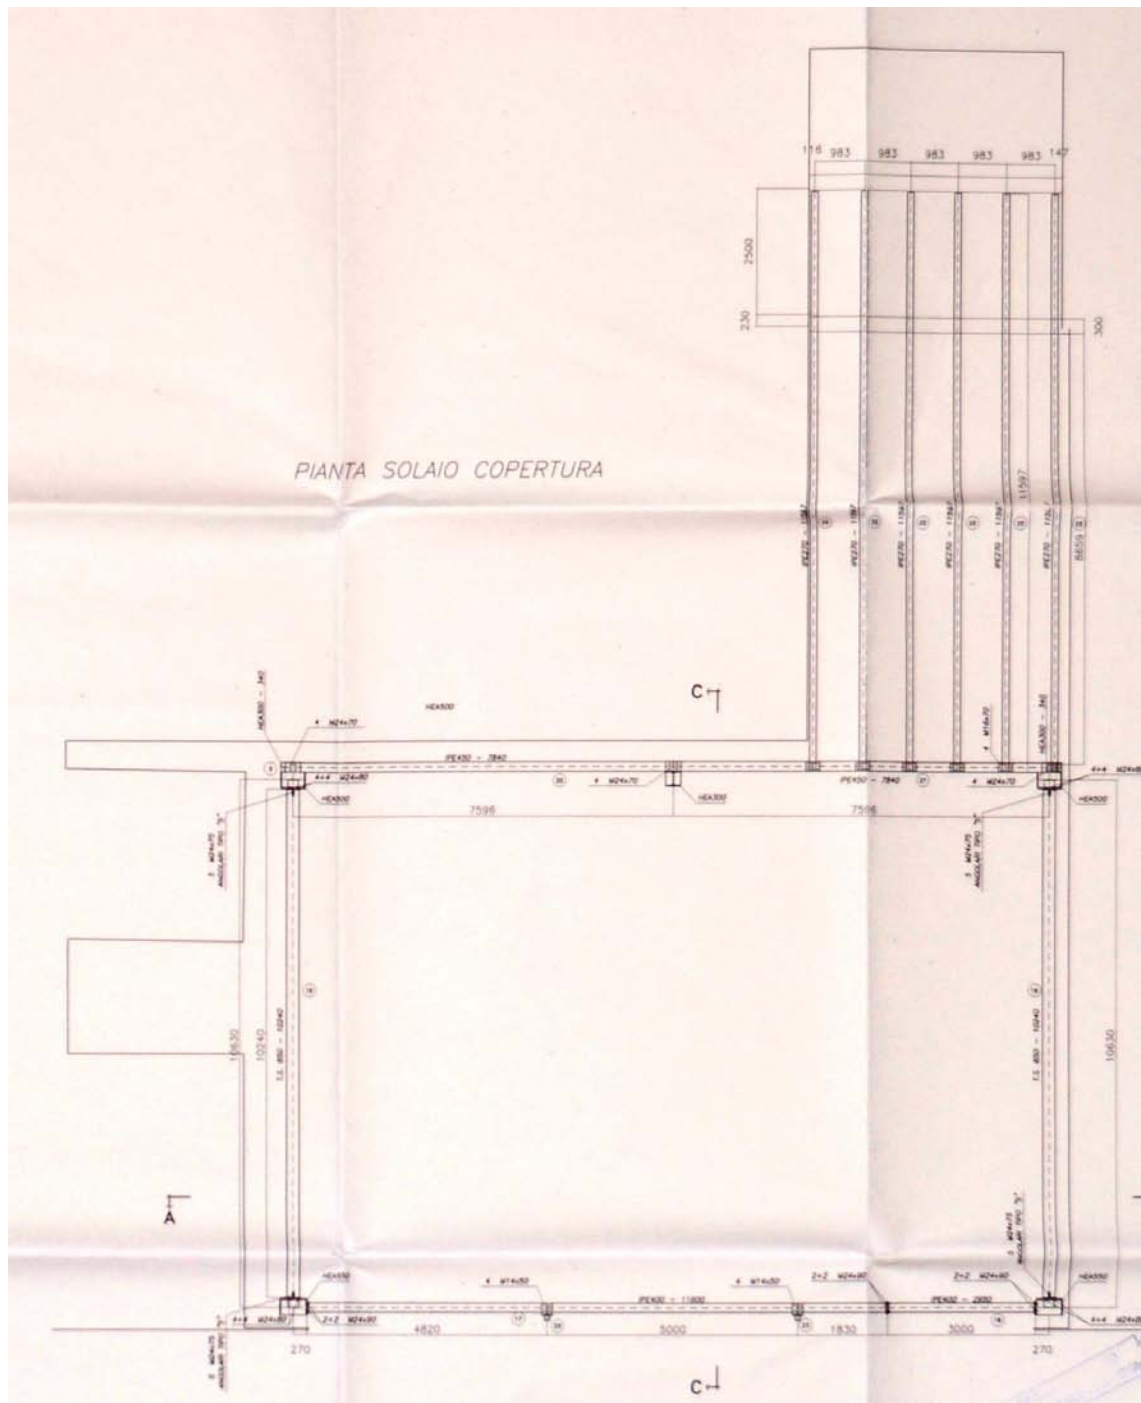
Particolare di A.2003.a.us.b.T04 - Piante - Pianta copertura
